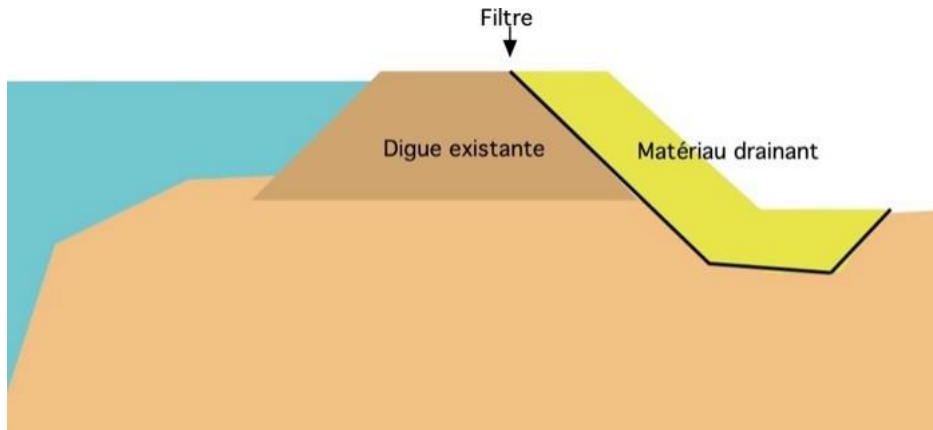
Recharge drainante du remblai et massif drainant en fondation (Schéma R.Tourment)
